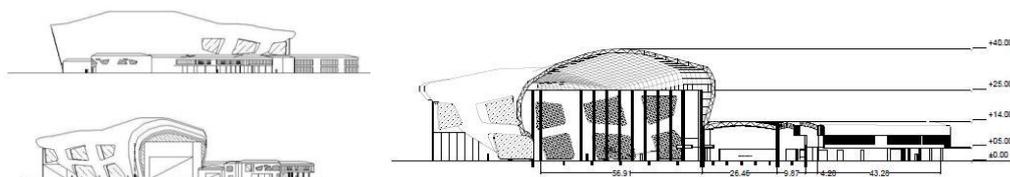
Rasio 1:4 profil dan penerapan dalam interior serta dampaknya pada eksterior
